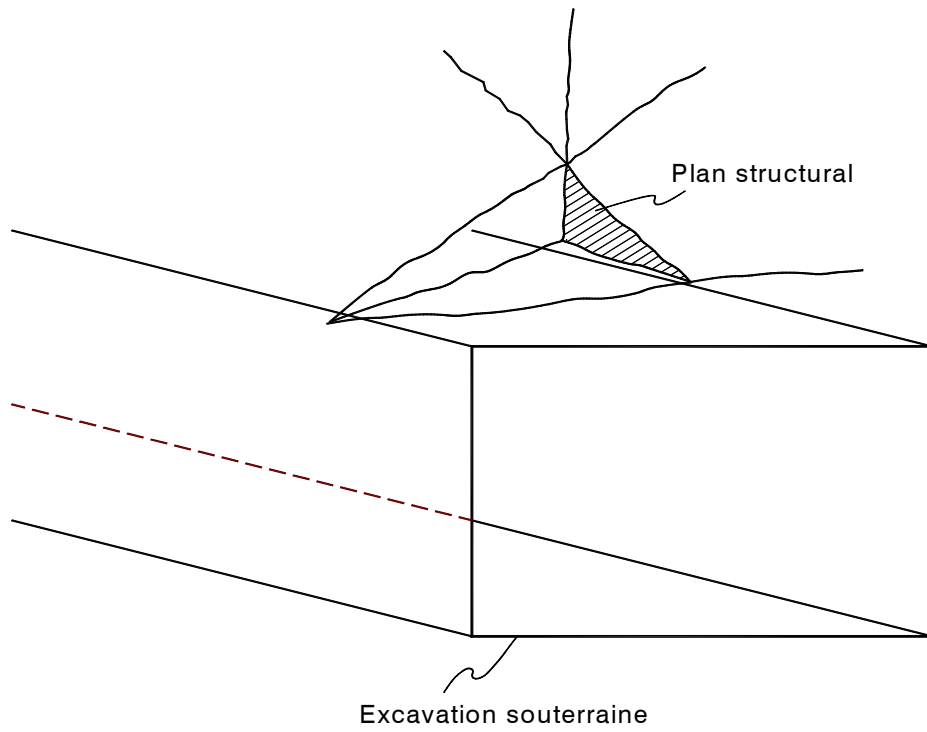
Tétraèdre partiellement exposé, formé par trois plans structuraux qui se rencontrent à proximité du toit d'une voie horizontale.
